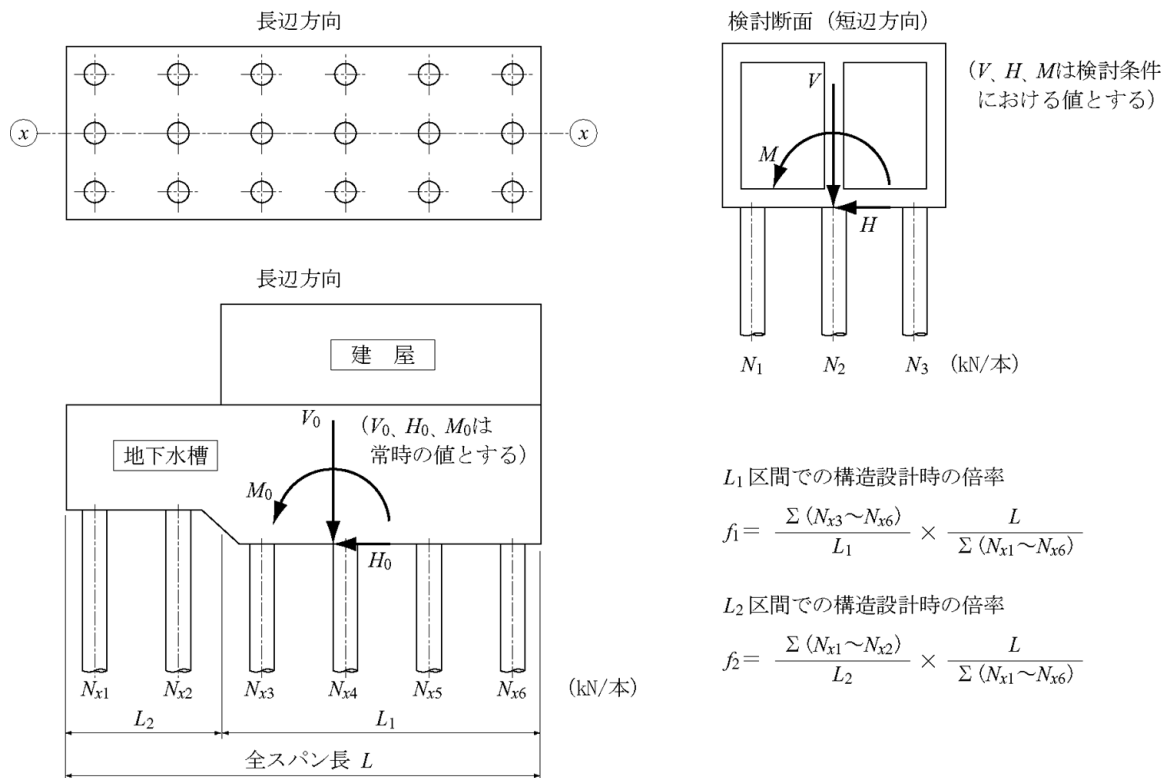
長辺方向に一様な断面の杭反力算定方法
